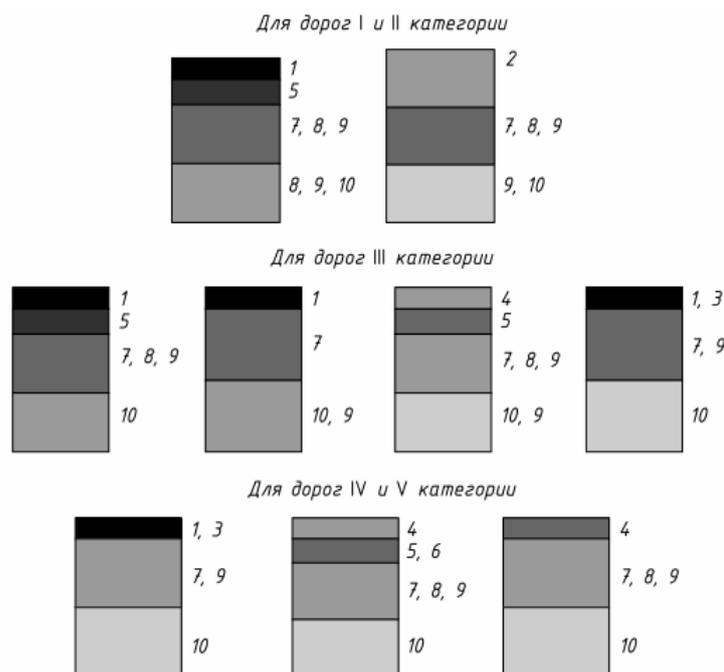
Конструкции дорожных одежд со слоями из укрепленных грунтов: 1 – одно- или двухслойное асфальтобетонное покрытие; 2 – цементобетонное покрытие; 3 – покрытие из битумоминеральной смеси; 4 – поверхностная обработка или тонкий защитный слой; 5 – черный щебень; 6 – покрытие, устроенное методом смешения или пропитки; 7 – основание или покрытие из грунта, укрепленного комплексными вяжущими; 8 – основание или покрытие из грунта, укрепленного органическими вяжущими; 9 – основание или покрытие из грунта, укрепленного минеральными вяжущими; 10 – слой основания из песка или крупнообломочного материала
